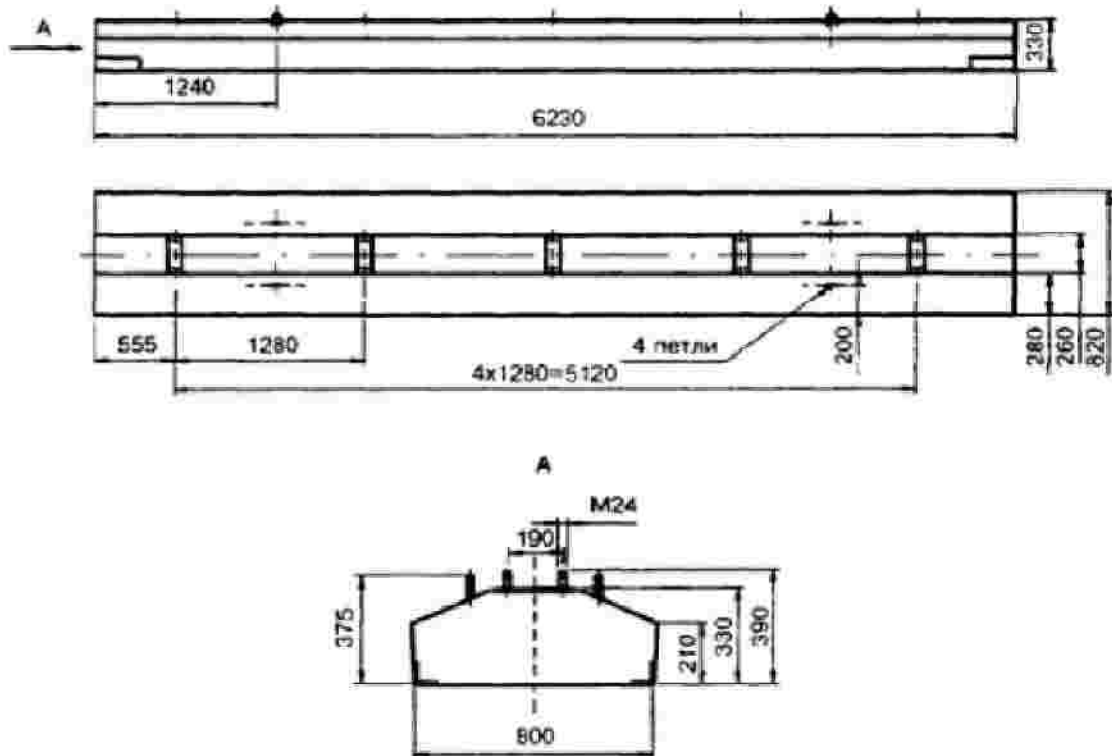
Железобетонная балка типа БРП-62.8.3
